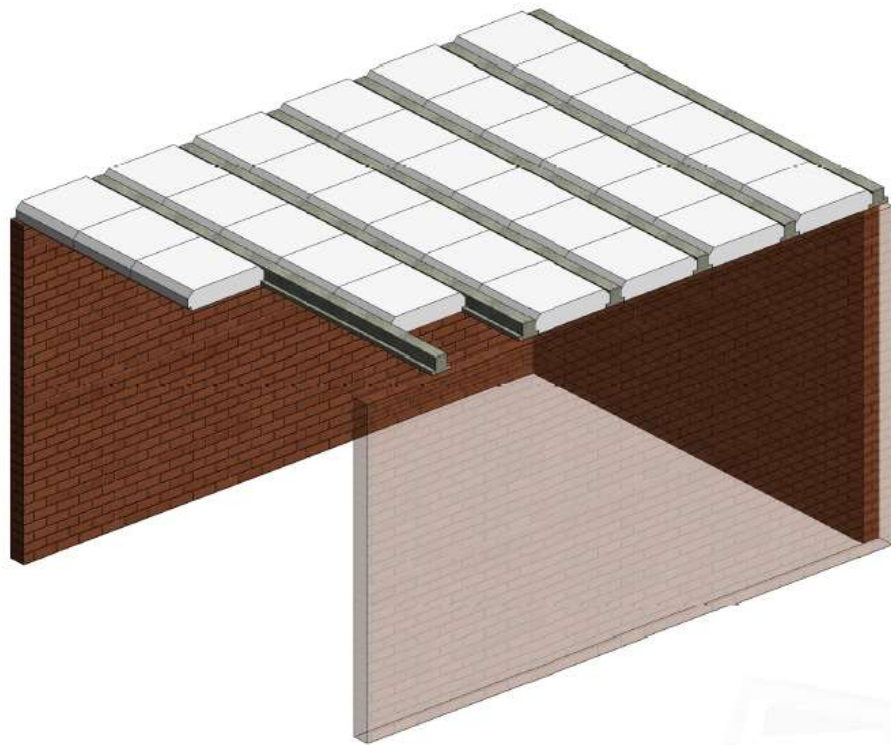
Esquema de montaje de Viguetas-Bovedillas de EPS
